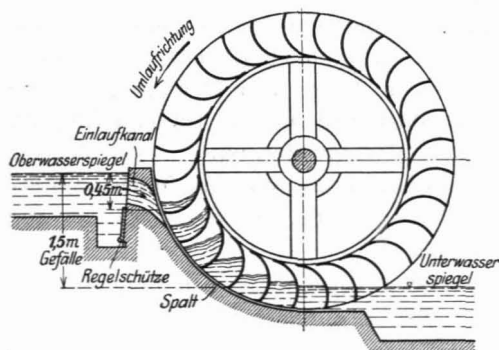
Richtig gebautes mittelschlächtiges Wasserrad (TWL 1603).
